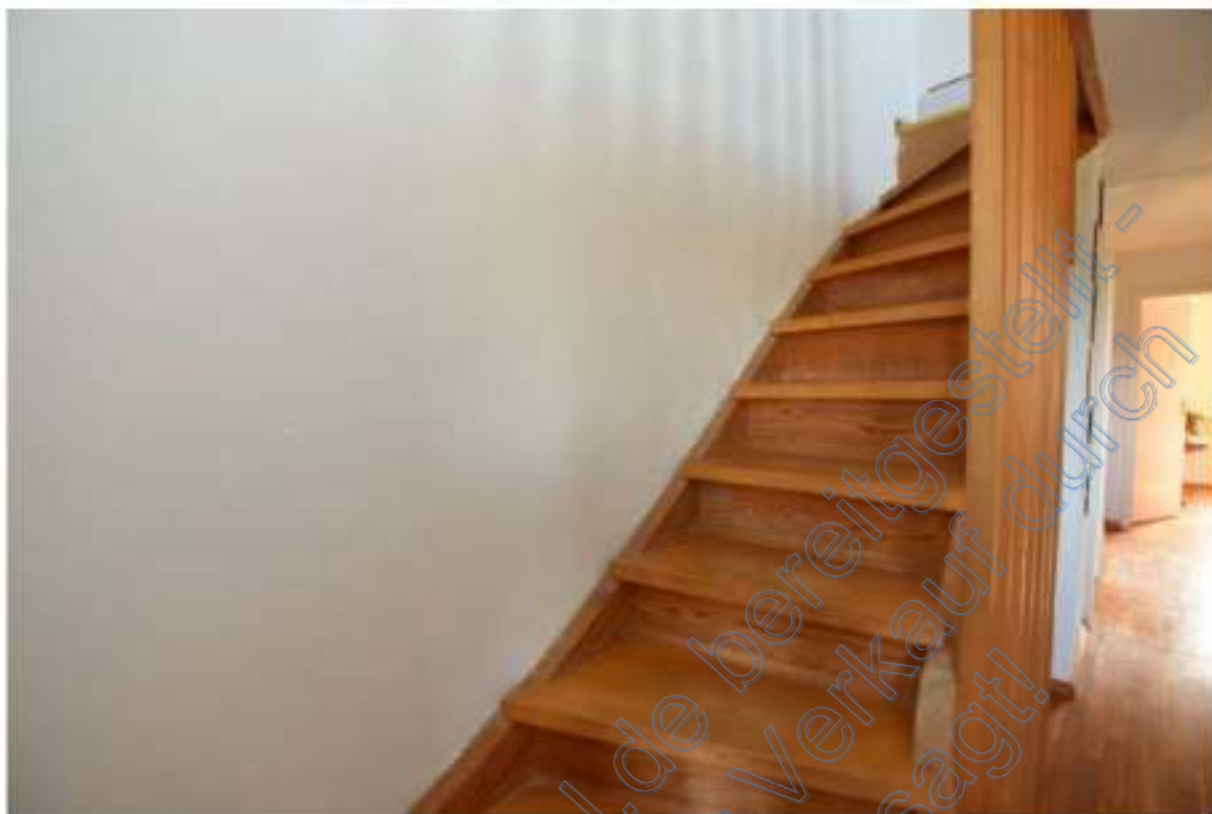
Dachgeschoss. Treppe in den Dachspitz
